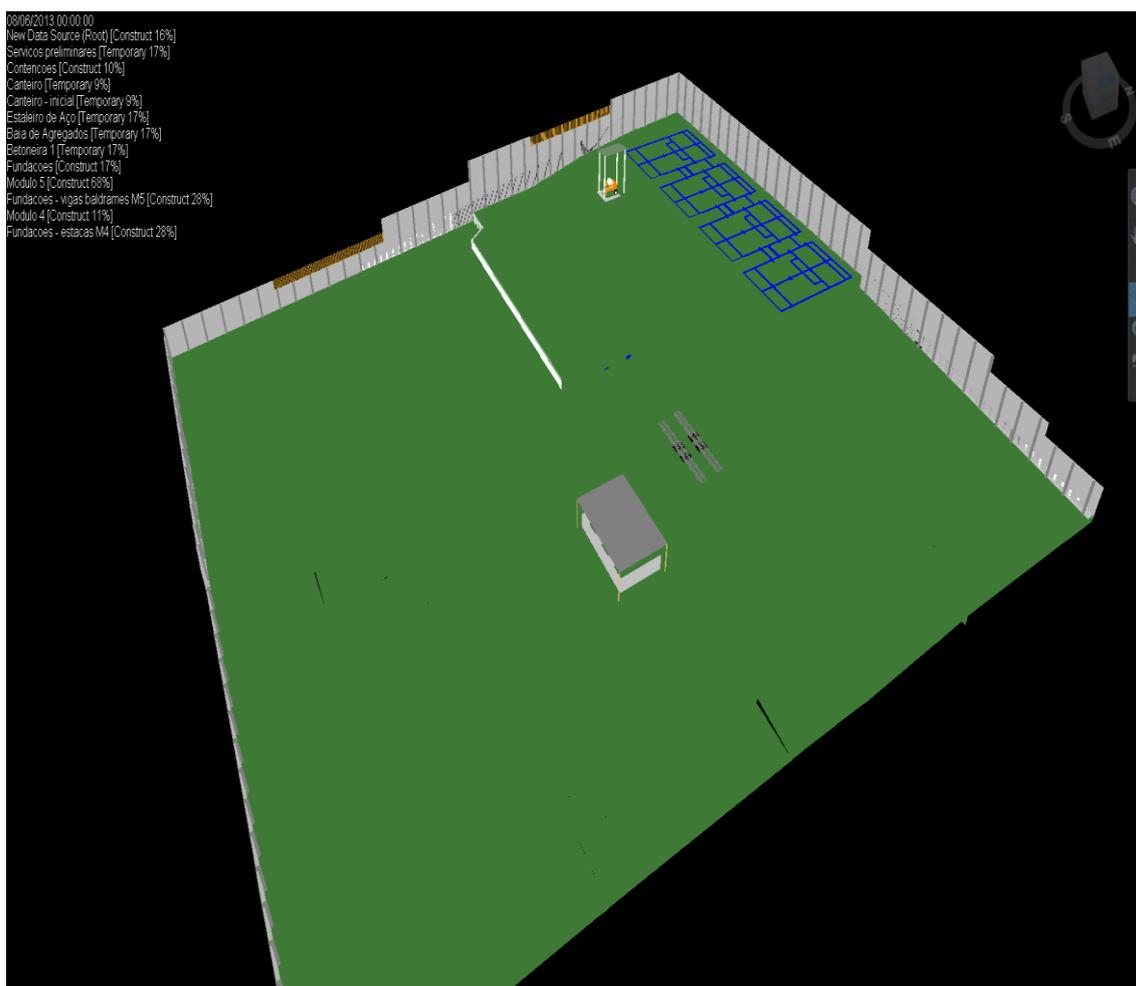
Planejamento em 08/06/13: fundações e canteiro
